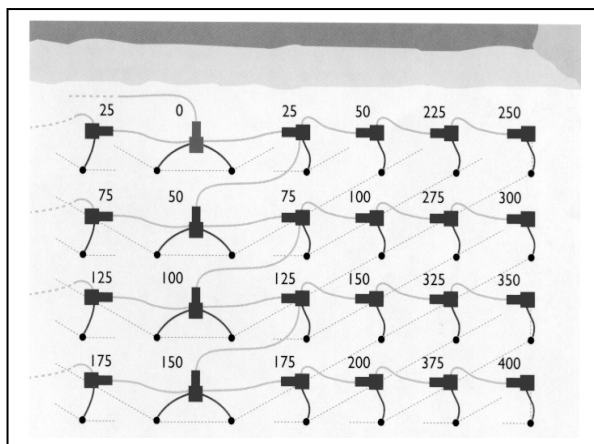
Configuração de malha regular de furação e sugestão de seqüenciamento de detonação.
